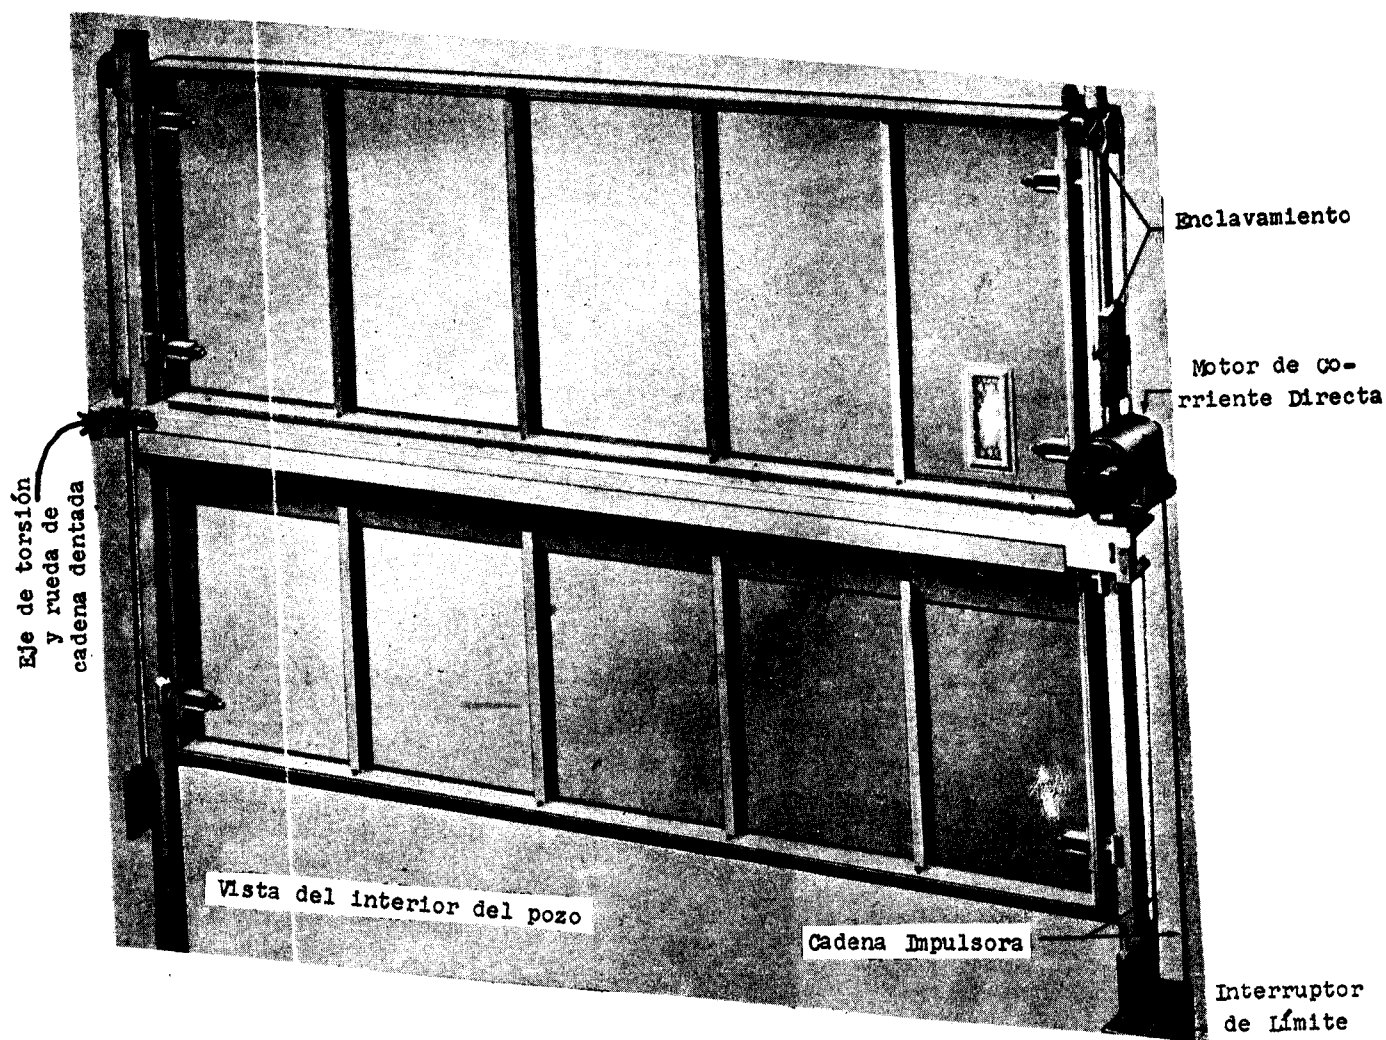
Vista demostrando un operador de puerta de pozo provisto en las instalaciones de ascensores de carga, donde una unidad de operación individual se instala para cada puerta de pozo o barrera de carro operado por fuerza motriz. Localizados accesiblemente de modo para facilitar la inspección y mantenimiento, estos operadores mecánicos funcionan mediante una unidad común de controles, y trabajan juntos en cada piso o apeadero de manera de proveer una coordinación suave y rápida de la operación por fuerza motriz de la puerta del pozo y la barrera del carro. Como demuestra la figura, una cadena para rueda dentada fijada a la sección inferior de la puerta y movida por un motor reversible de corriente directa, mueve la sección inferior de la puerta en ambas direcciones. Montado bajo el umbral de acarreo de la sección inferior de la puerta hay un eje torsional de acero que se extiende a lo largo del ancho de ésta. Dos ruedas para cadena dentada en cada extremo del eje engranan a cadenas idénticas que están fijadas a los carriles de guía, las cuales al rotar mantienen las fuerzas a los extremos de la puerta siempre en balance al moverse en subida o bajada.
